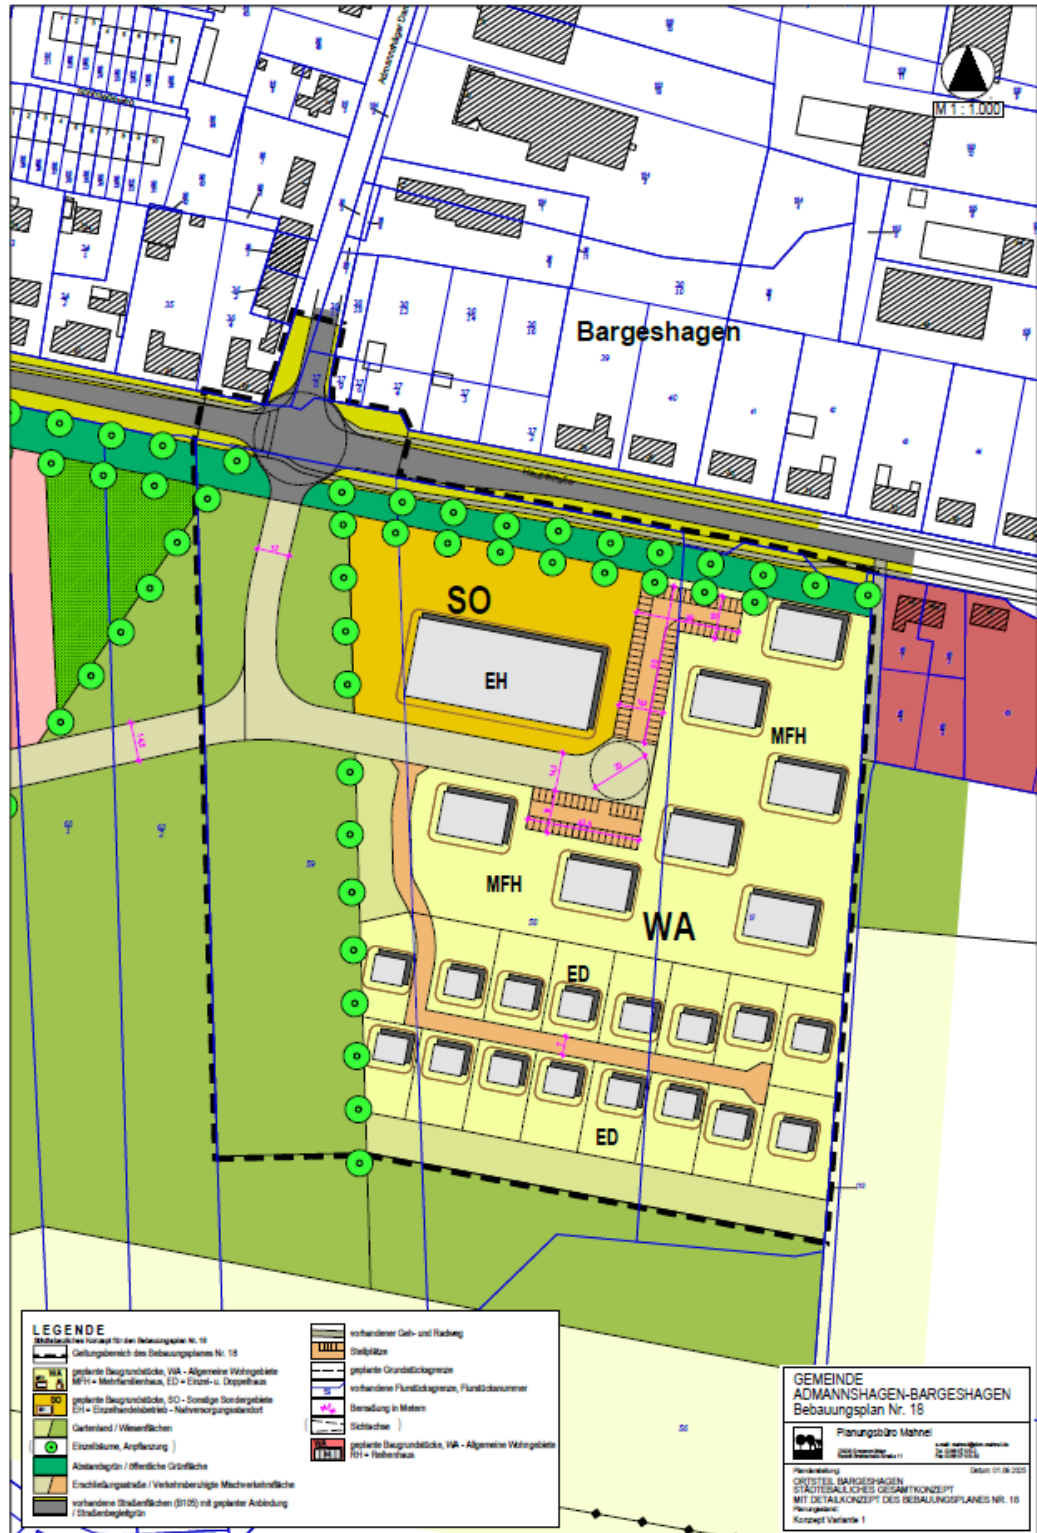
Städtebauliches Gesamtkonzept mit Detailkonzept B-Plan Nr. 18 Konzept Variante 1
